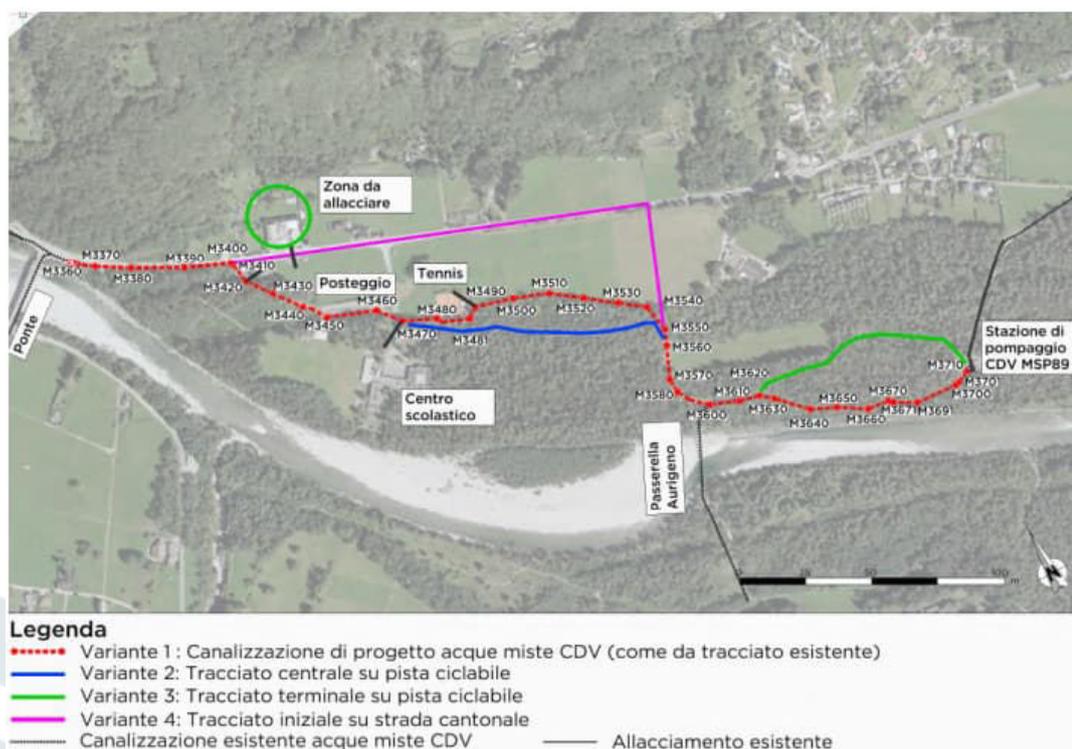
Illustrazione planimetrica delle varianti di tracciato analizzate nello studio di varianti
